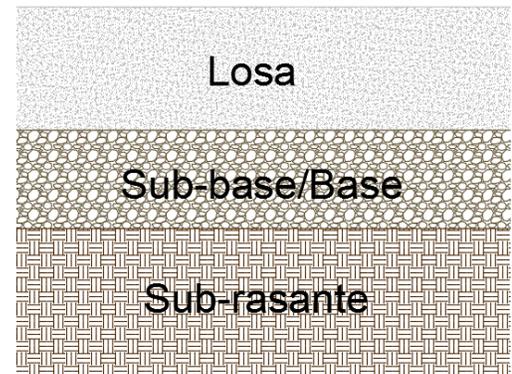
Estructuración de pavimento rígido. Fuente: Elaboración propia (2016) AutoCAD.
